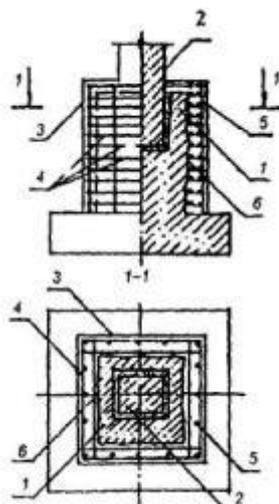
1 - подколонная часть фундамента; 2 - колонна; 3 - железобетонная обойма усиления подколонной части фундамента; 4 - поперечные арматурные сетки обоймы; 5 - вертикальные арматурные стержни обоймы; 6 - поверхность подколонника, подготовленная к бетонированию (зачистка и насечка).
